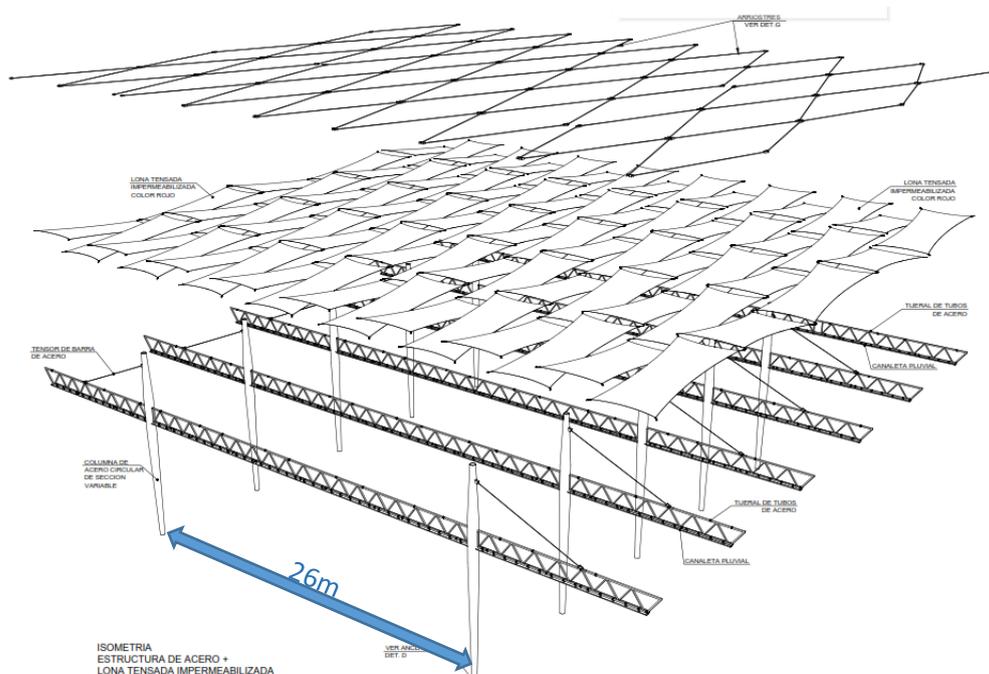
Estructura de acero propuesta para la cobertura central
